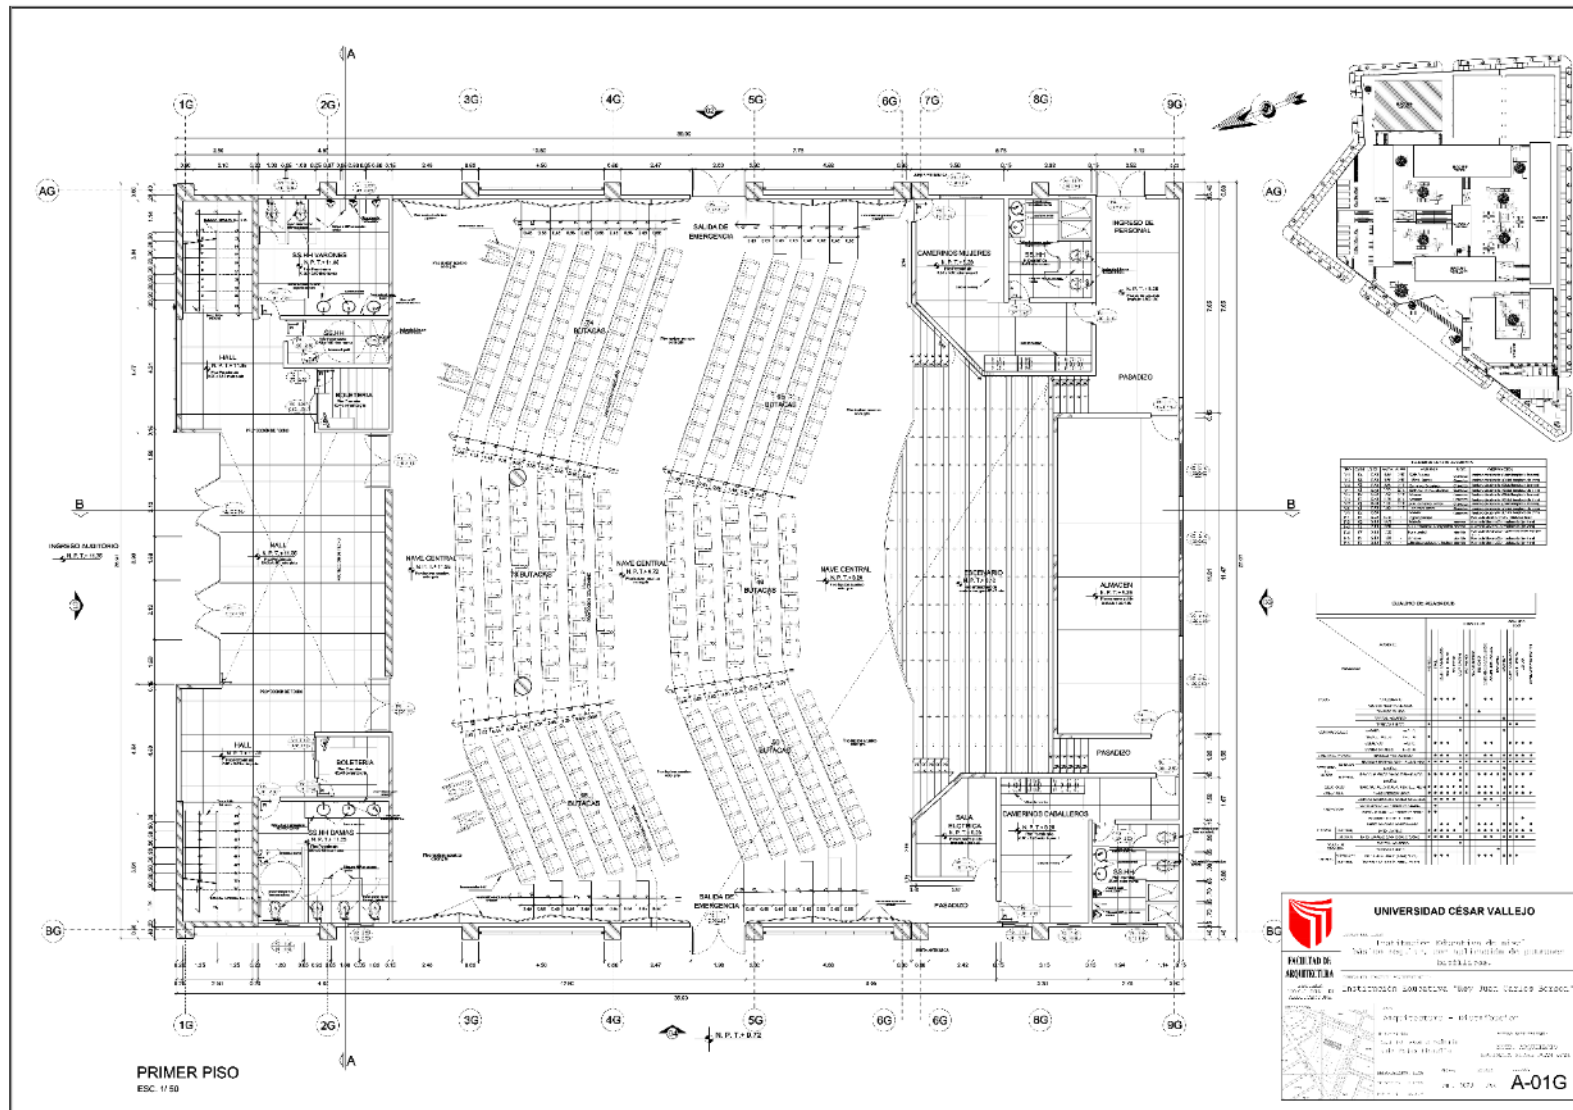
Plano Primera planta bloque "G", Fuente: elaboración propia
